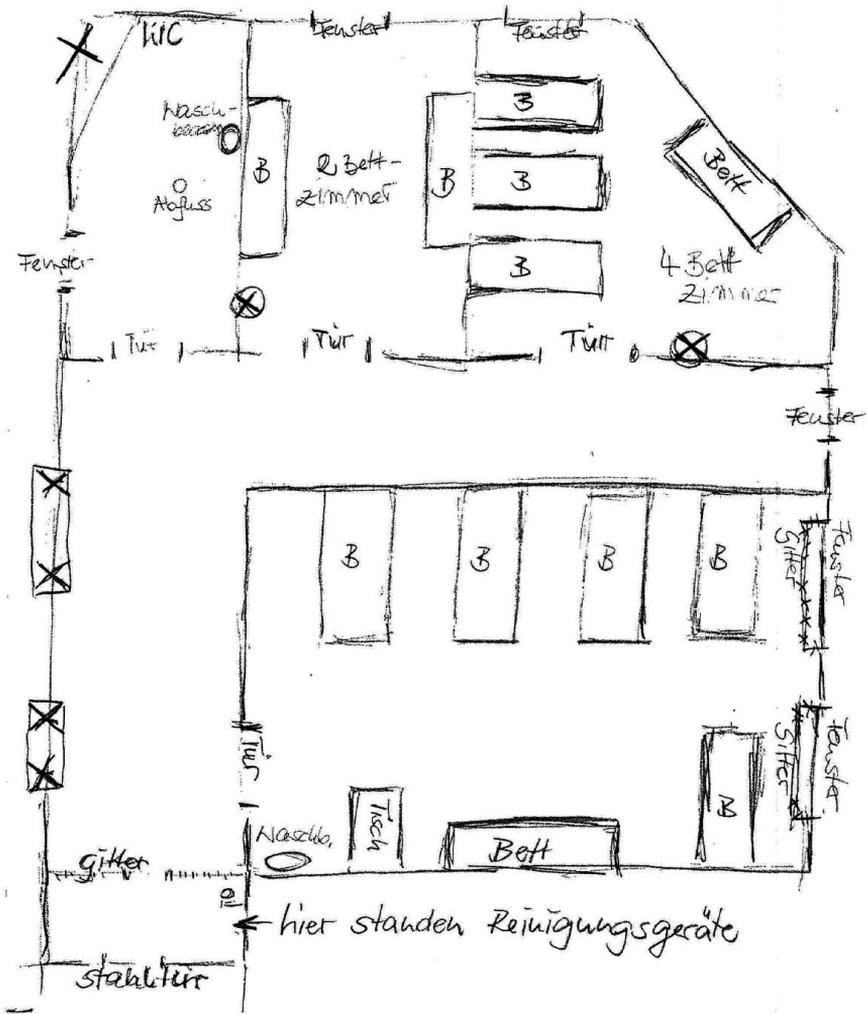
Grundriss der Station 114 C der geschlossenen Venerologischen Station in Berlin-Buch (Rekonstruktion 2014)
